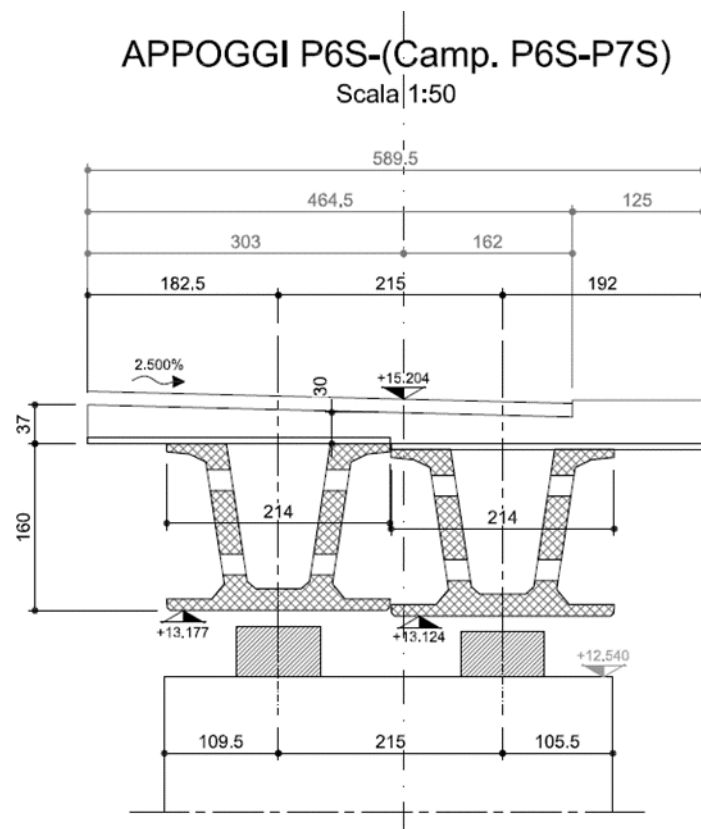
Sezione trasversale su P6S – Rampa S
